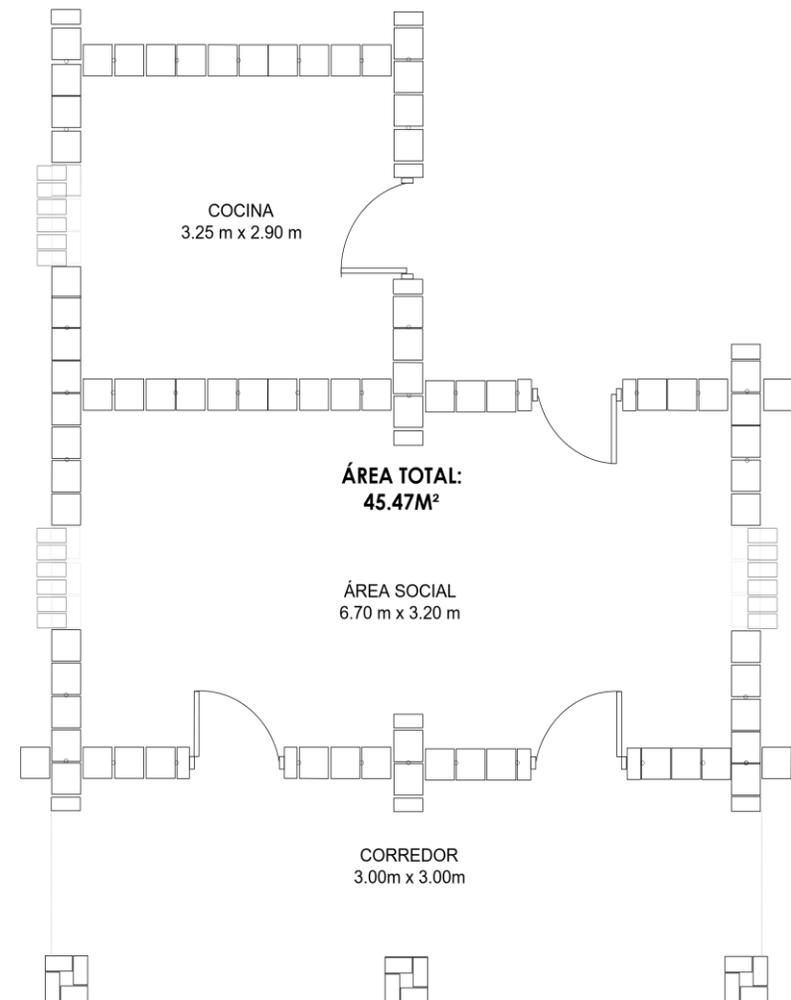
Planta tipo para vivienda de interés social con el sistema adobe reforzado. Fuente: FUNDASAL.
